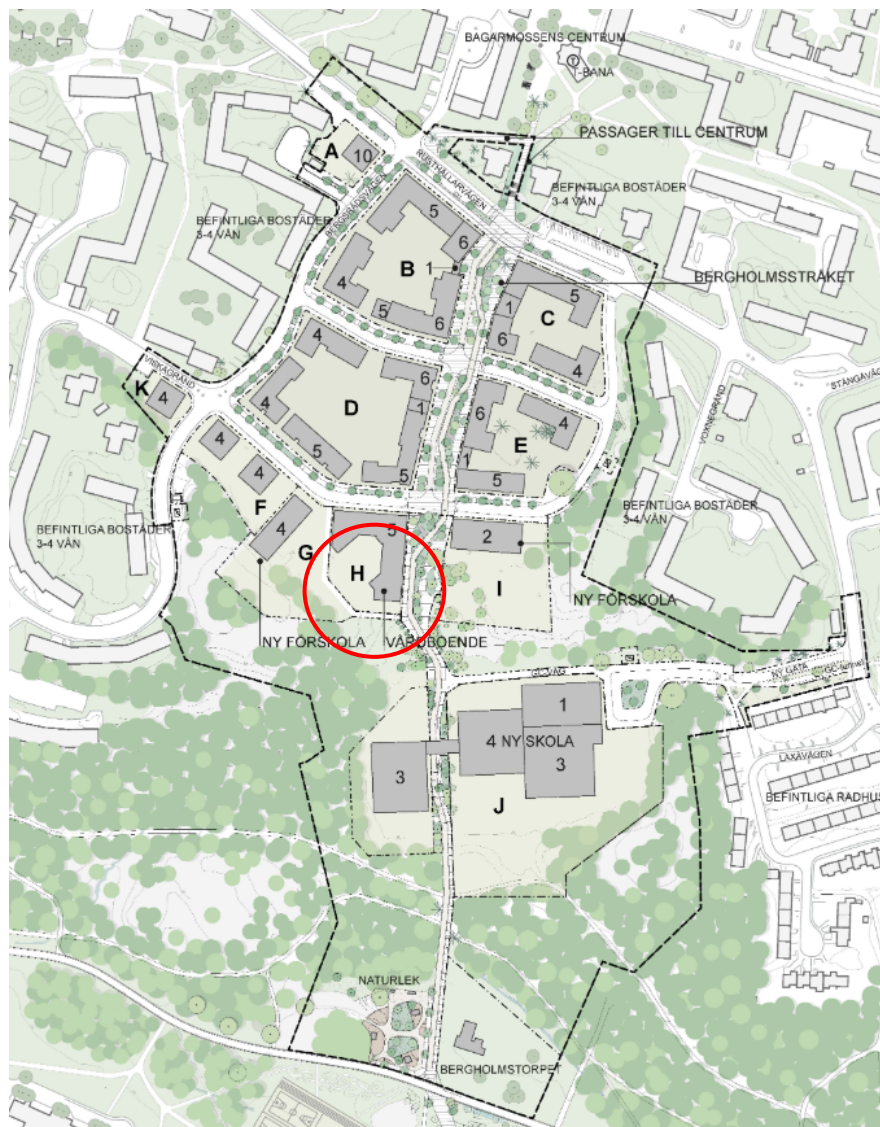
Överblicksbild av planområdet. Det planerade vård- och omsorgsboendet är inom kvarter H.
